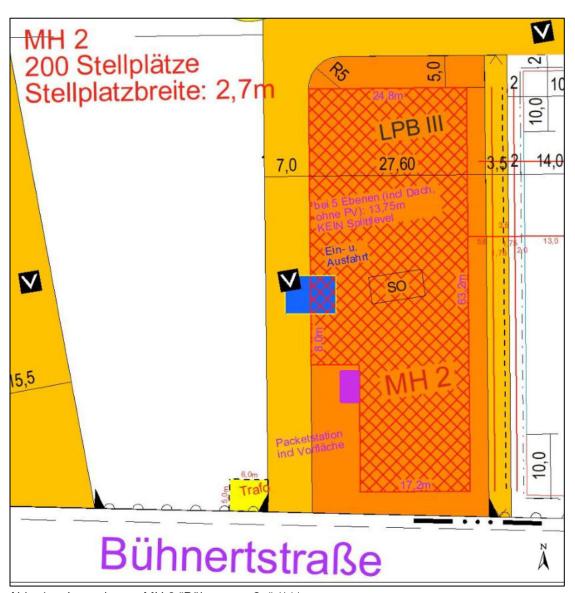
Lageplan zu MH 2 "Bühnertstraße" /11/
